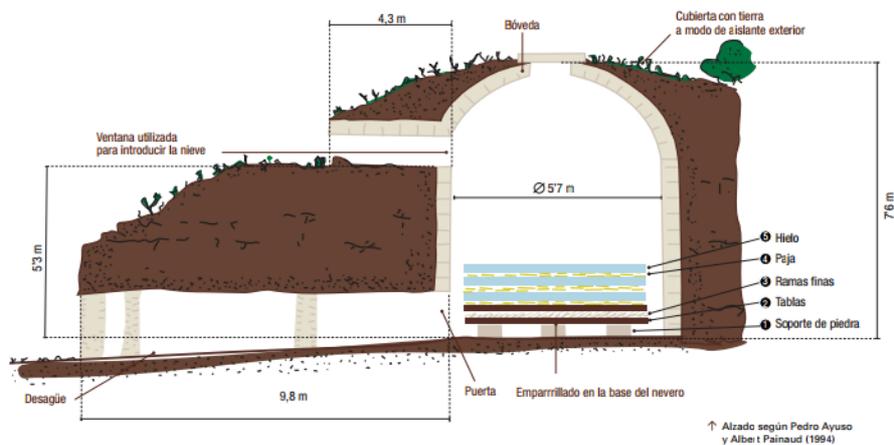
Ejemplo construcción pozo de hielo. Fuente: Pedro Ayuso y Albert Painaud..
